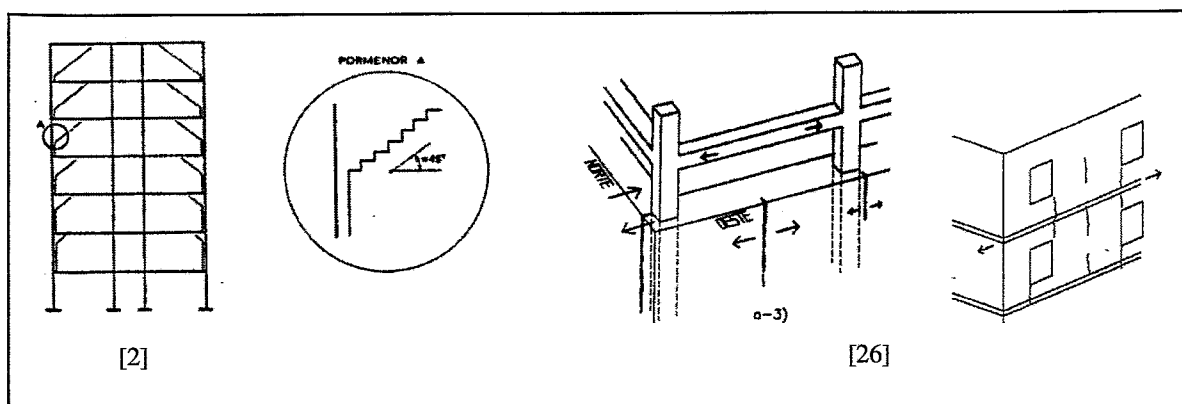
Fissuração típica nos panos de alvenaria devida a dilatação das estruturas reticuladas
